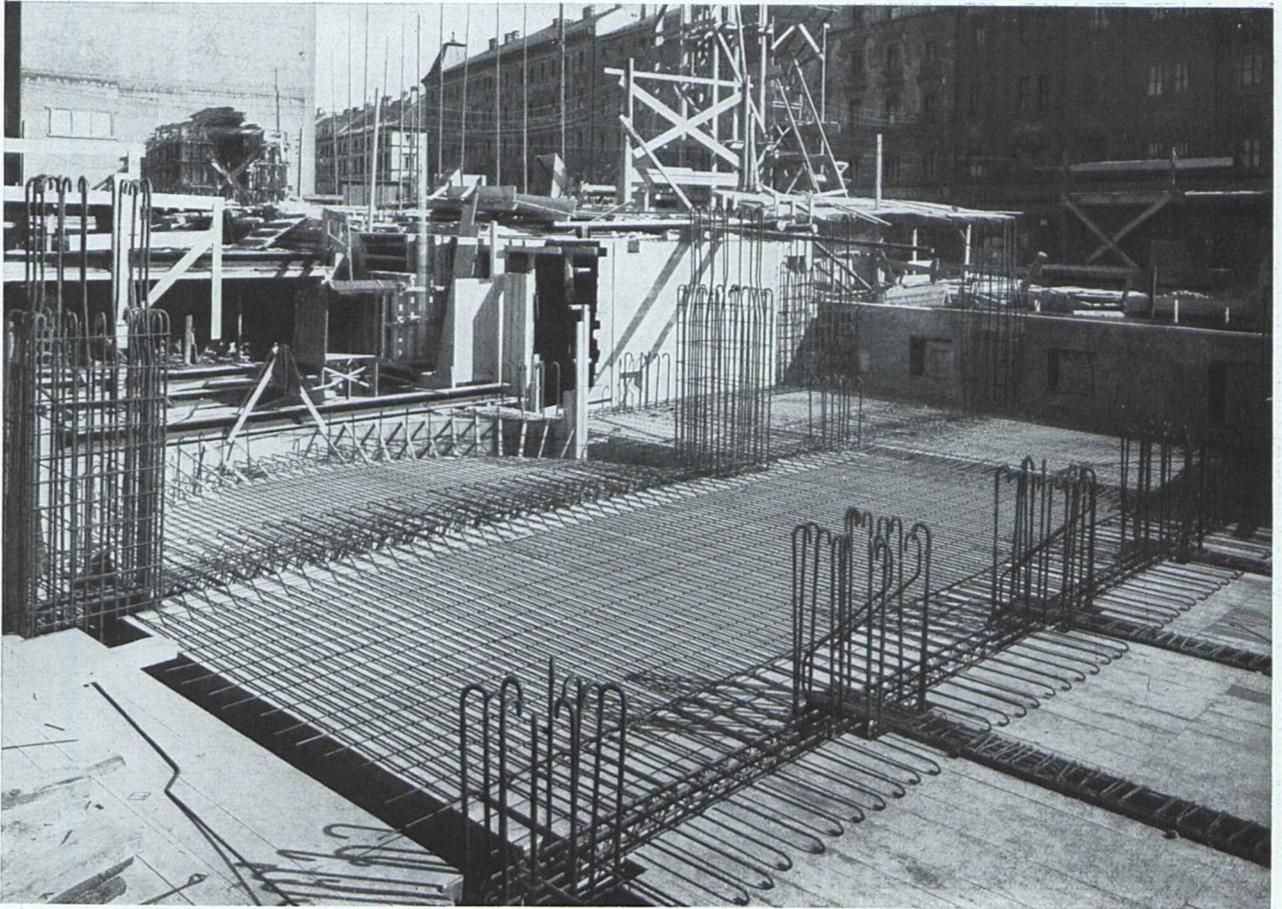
Bauausführung: Karl Stöhr, Bauunternehmung, München, Schwanthalerstraße 11
